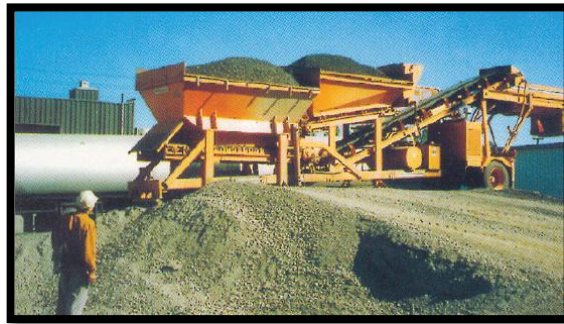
Reciclado en Planta Con Asfalto Espumado
